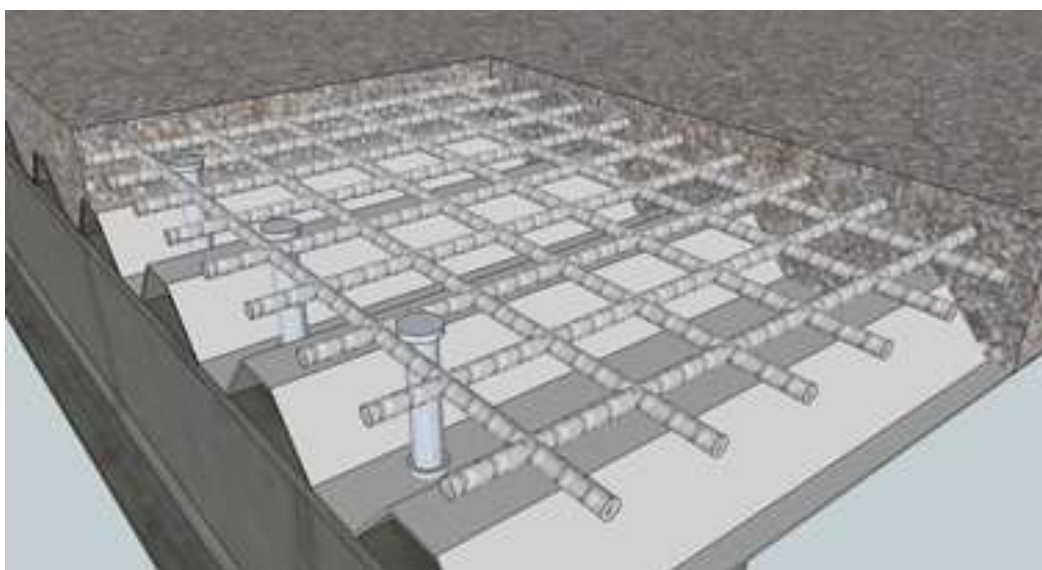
Laje Steel Deck, mostrando os conectores de cisalhamento e a malha de combate à fissuração.
